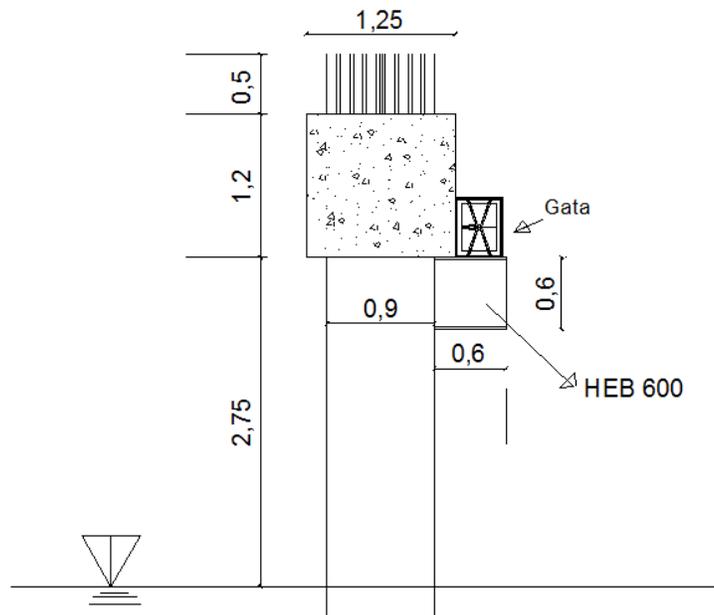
Esquema de viga de coronamiento, con apoyo de perfil HEB 600
